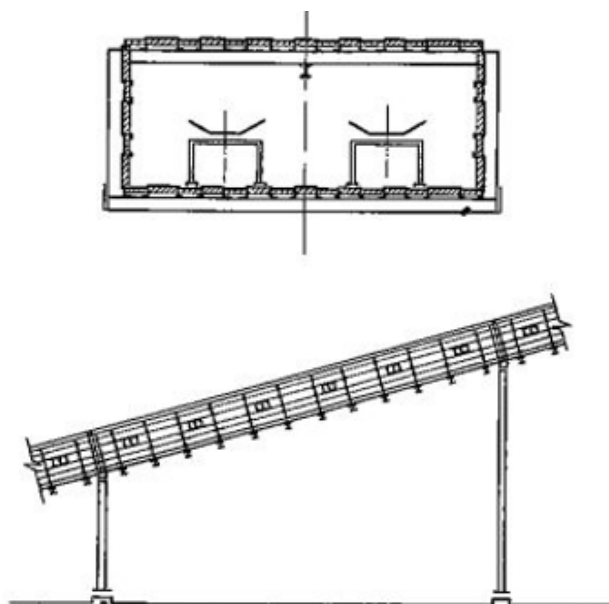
Пролетное строение конвейерной галереи с несущими конструкциями из оболочки прямоугольного сечения
